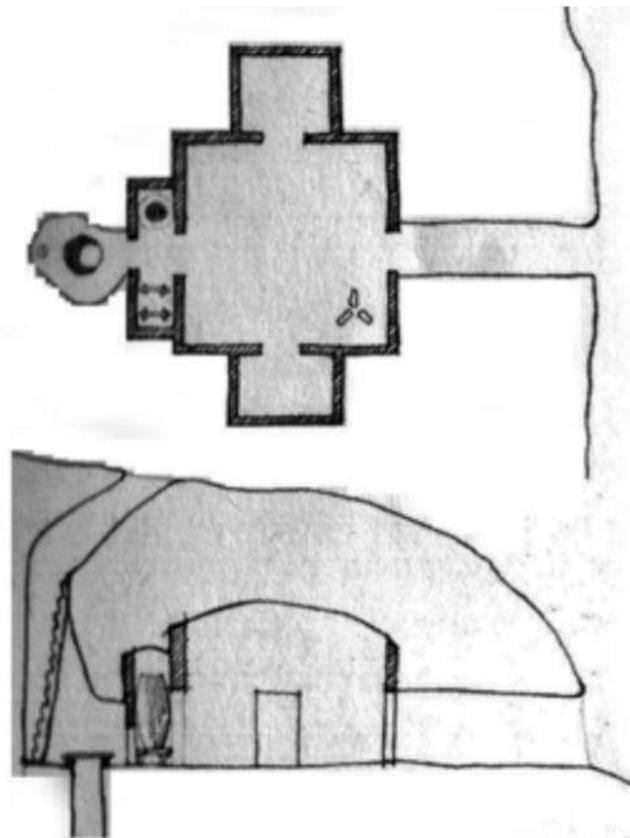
Vivienda enterrada, Planta y corte. Gruta de Mopti. Tomado de (Camesasca,1971).
